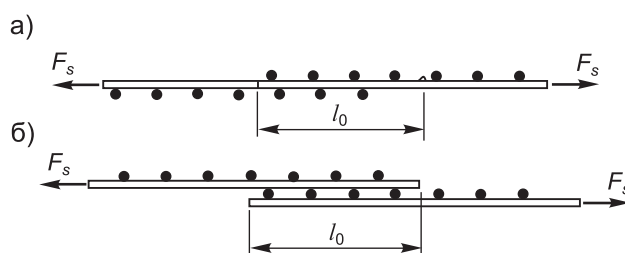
Схемы соединений внахлест для сварной сетки:
